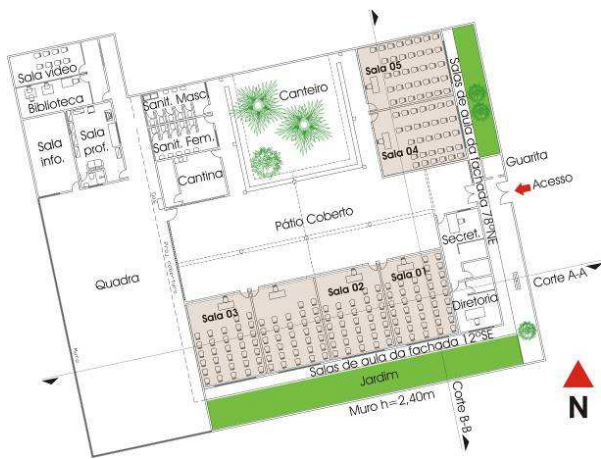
Planta baixa da escola indicando acesso e localização das salas de aula.
